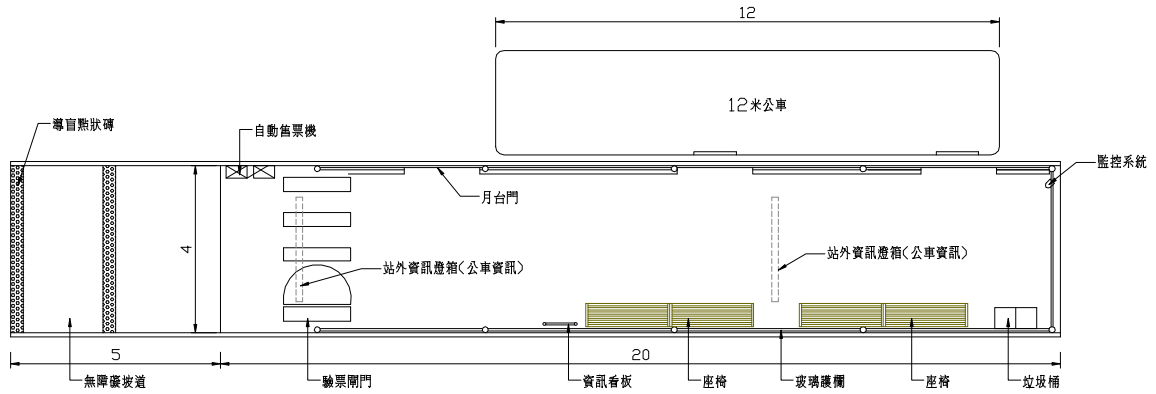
BRT 車站站體(4 公尺寬)平面配置示意圖
